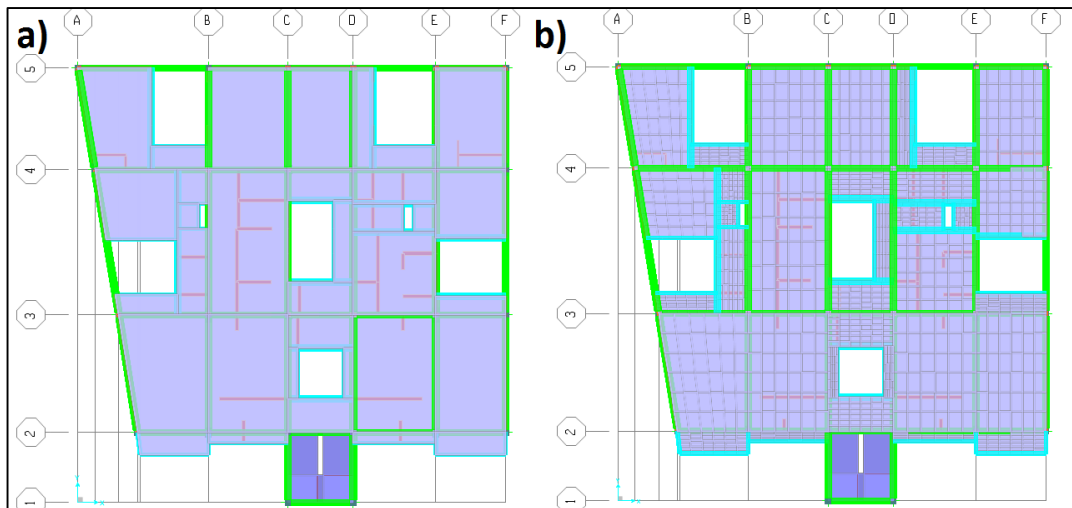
Ejemplo Estructuras aporticada. (A) Tipo de plano A, (b) Tipo de plano B.
